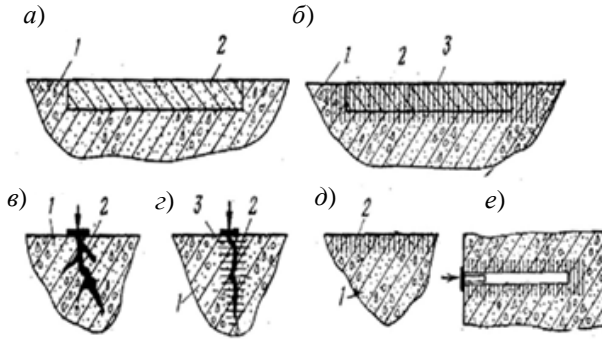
Схемы ремонта бетонных и железобетонных конструкций:
